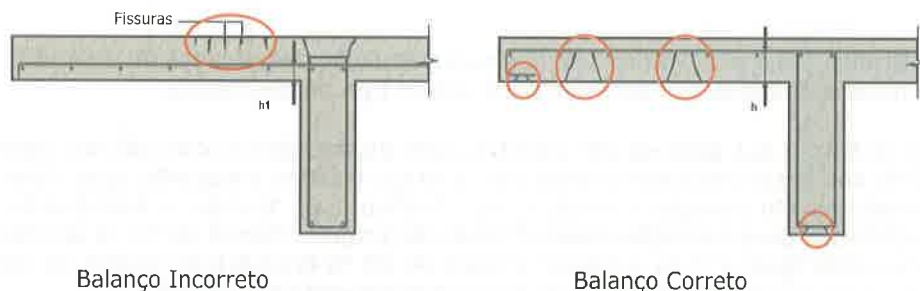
Fissuras em elementos solicitados a flexão
